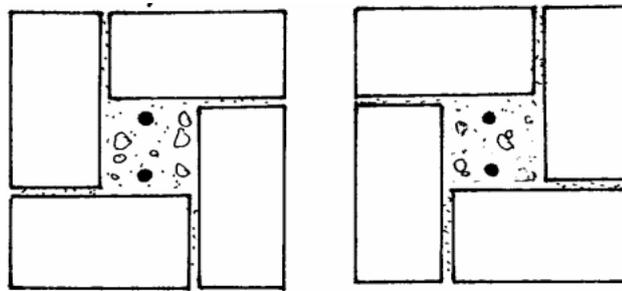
Pilar de um bloco em torno de um núcleo preenchido por argamassa
